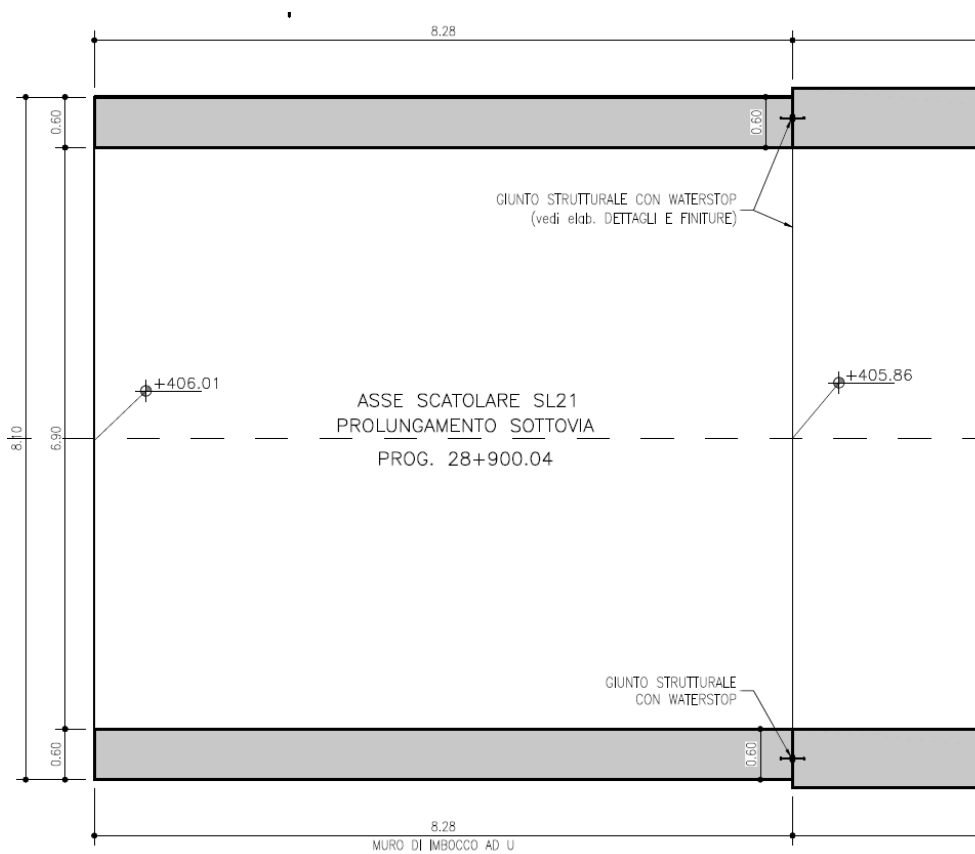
Muri d'imbocco - Pianta inferiore
